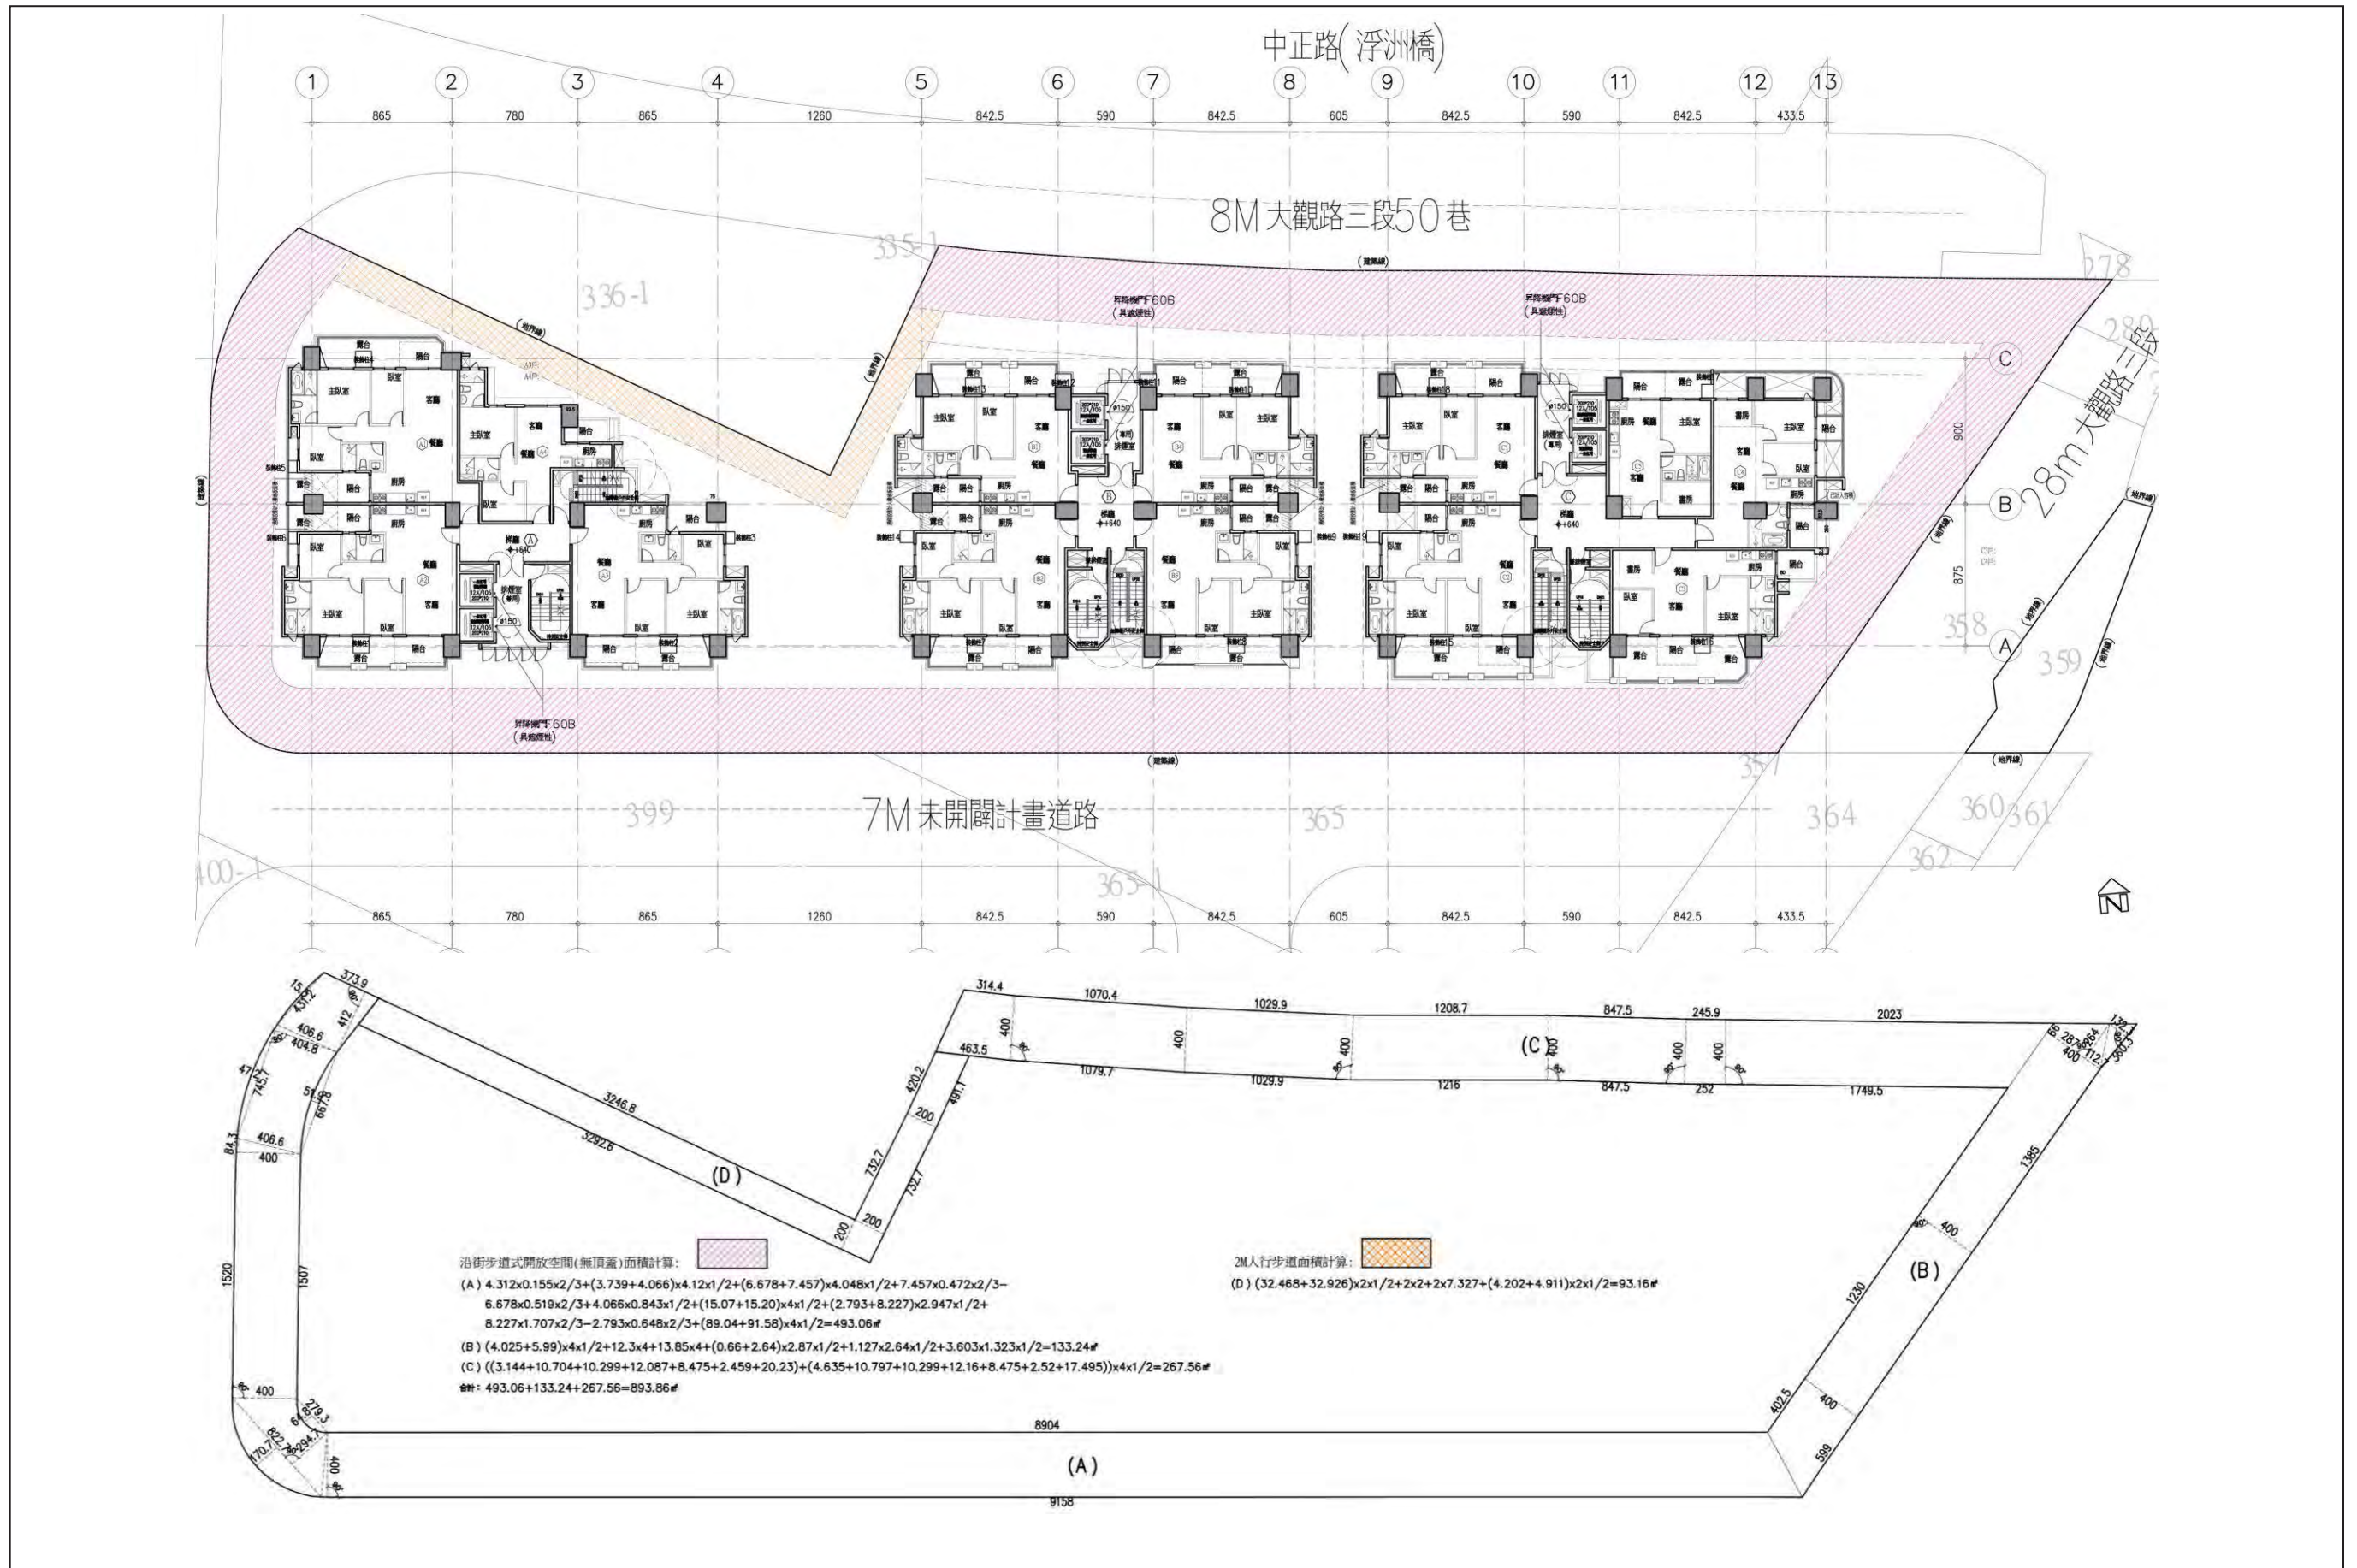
開放空間套繪二層平面示意圖(S : 1/400)
